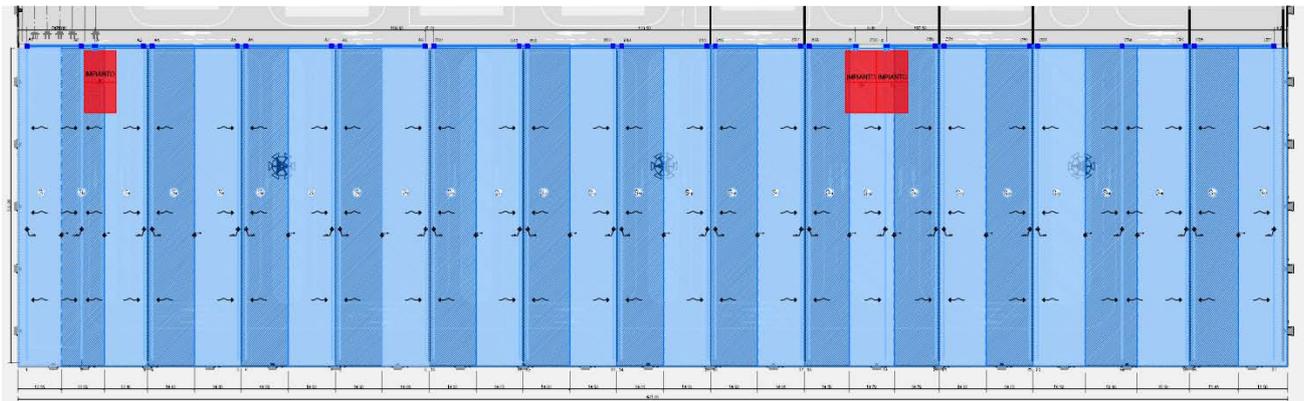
Planimetria dei bacini scolanti della rete di drenaggio
